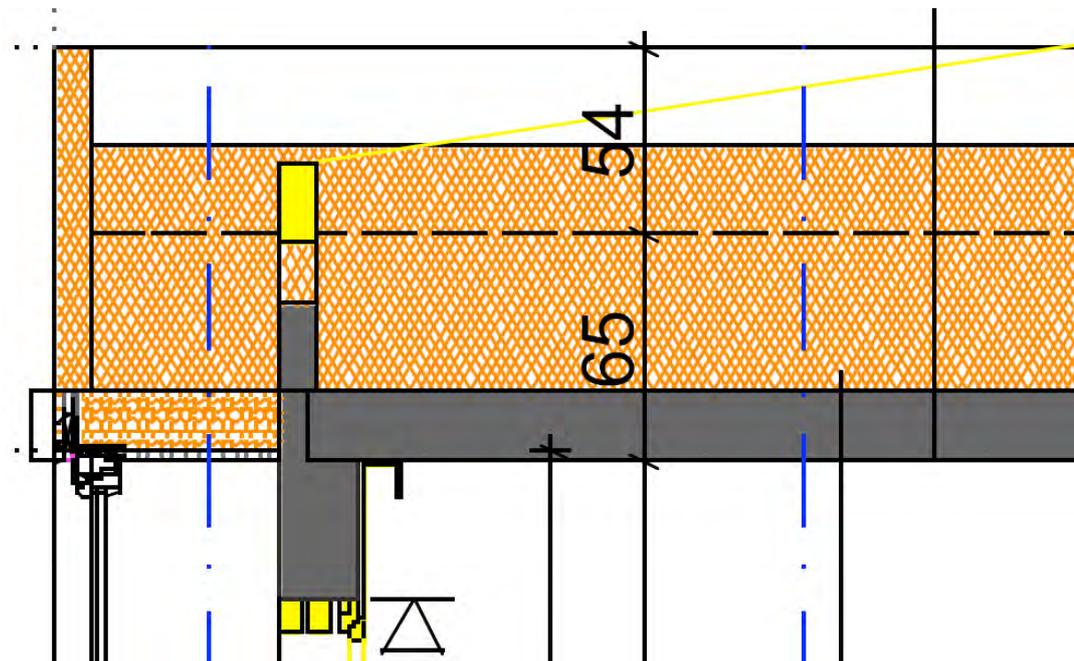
Detailschnitt Dachaufbau – Wärmebrückenfreie Attikaausbildung
